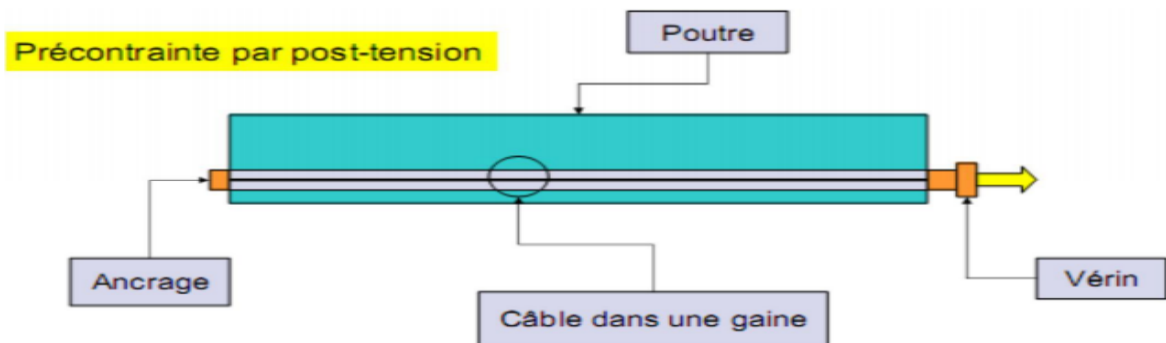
Coupe longitudinale d'une poutre en béton précontraint par post-tension
